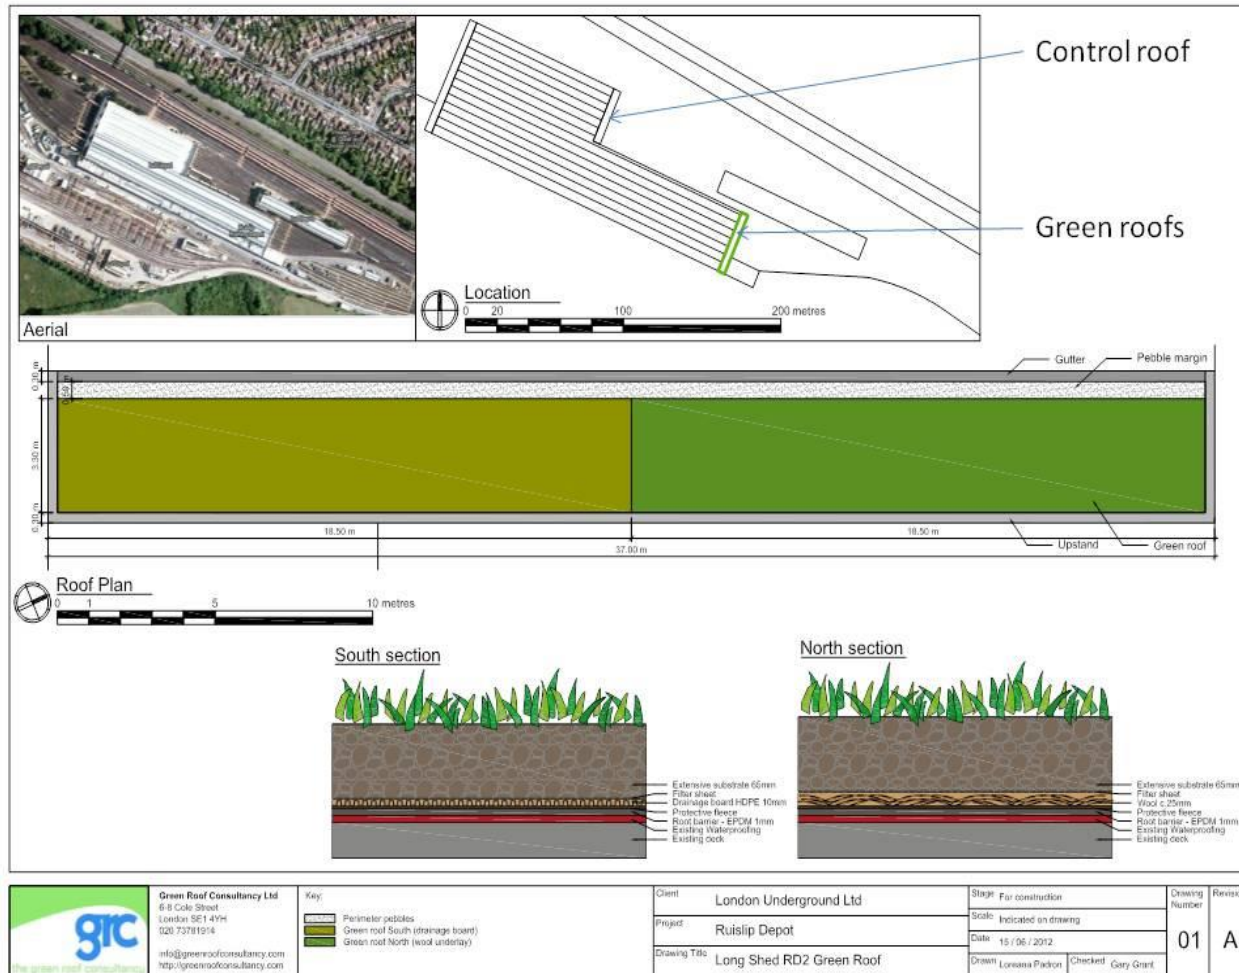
Design do telhado verde - seção norte e sul (© Green Roof Consultancy Ltd, 2013)
